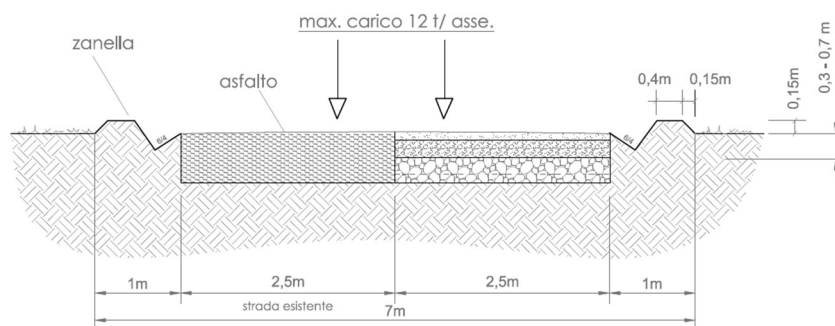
Sezione stradale tipo nel caso di allargamento della sede stradale esistente
